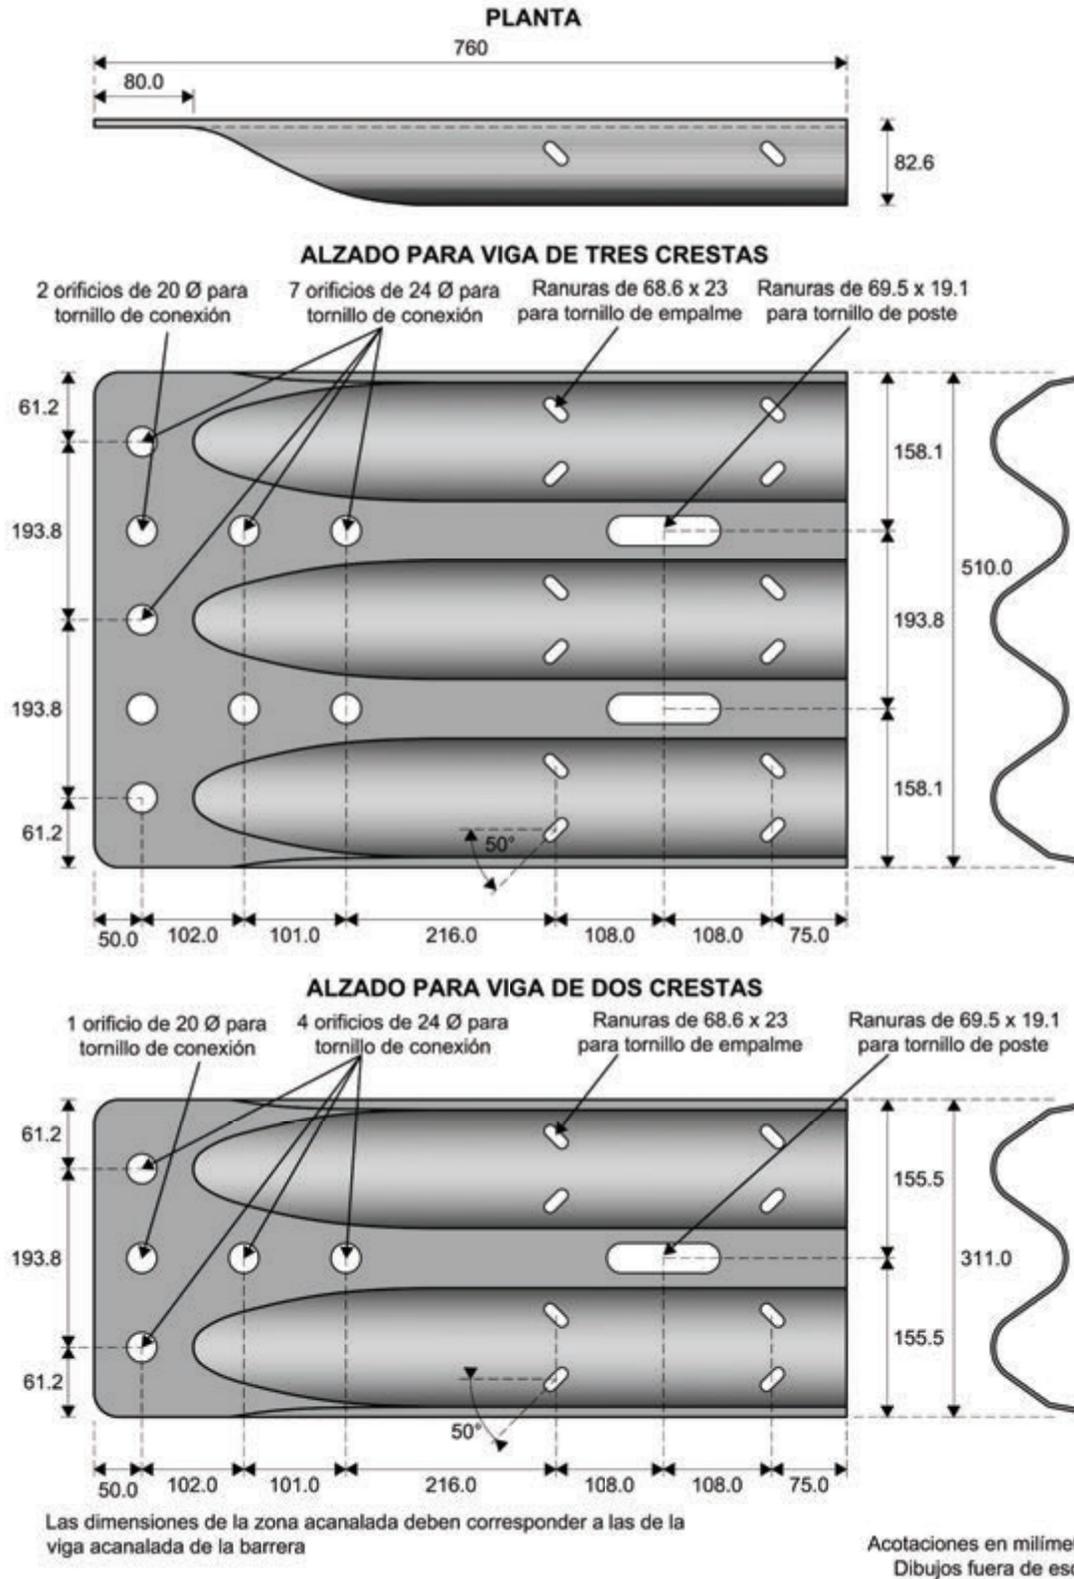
Zapatas de conexión para barreras de vigas acanaladas de acero
